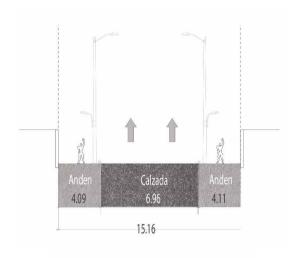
Perfil vial existente - Av. Colón (Calle 13) Fuente: Elaboración propia
